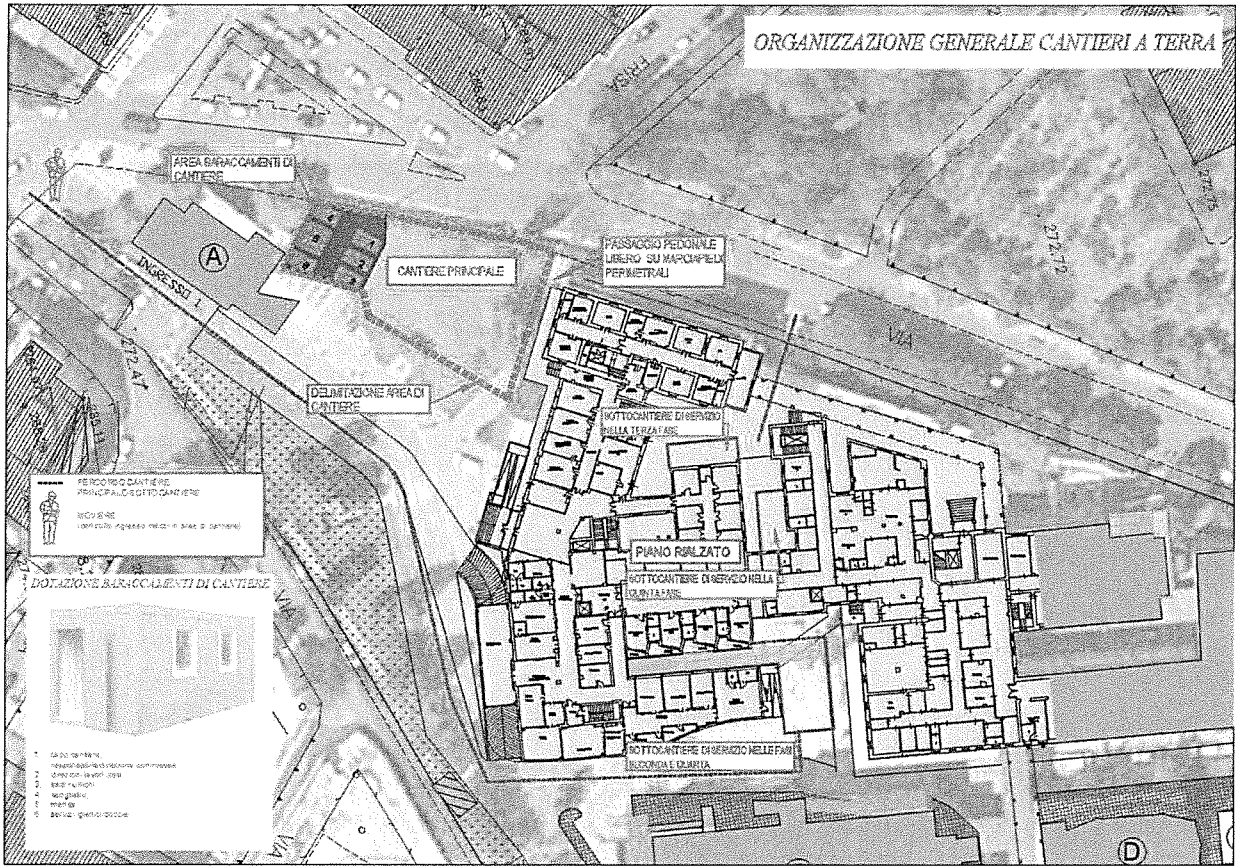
pianta piano terra, layout cantiere principale e sottocantieri
